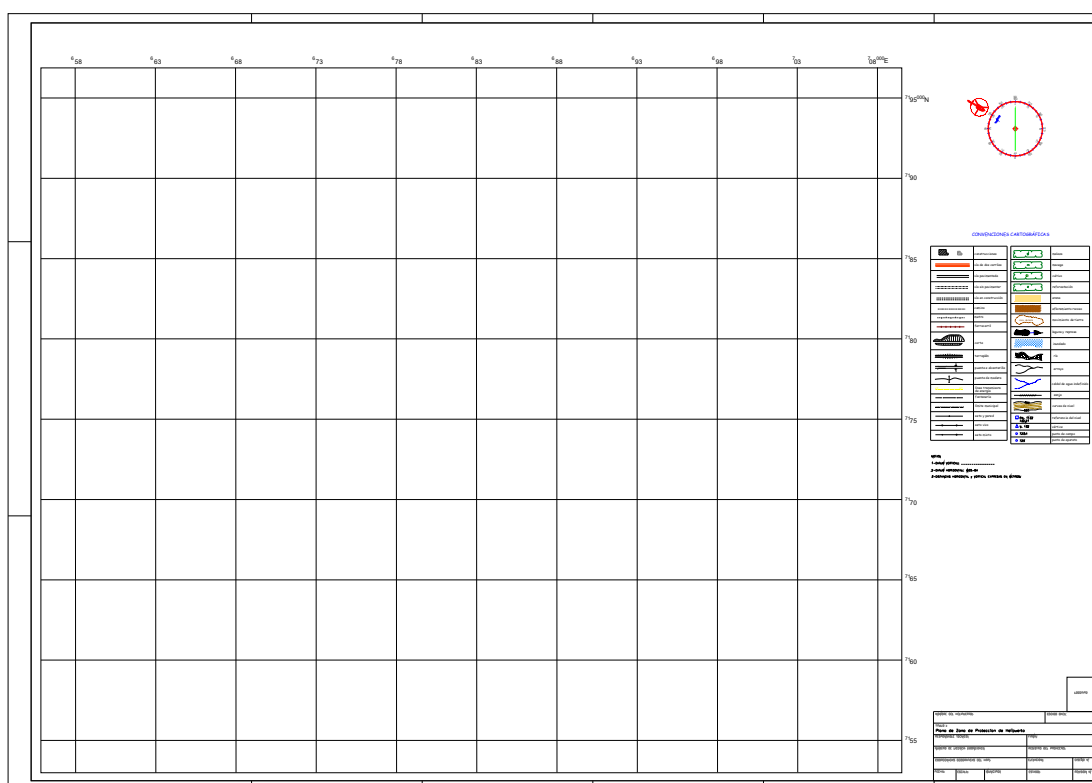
Modelo de Planta de los Planos de Zona de Protección
